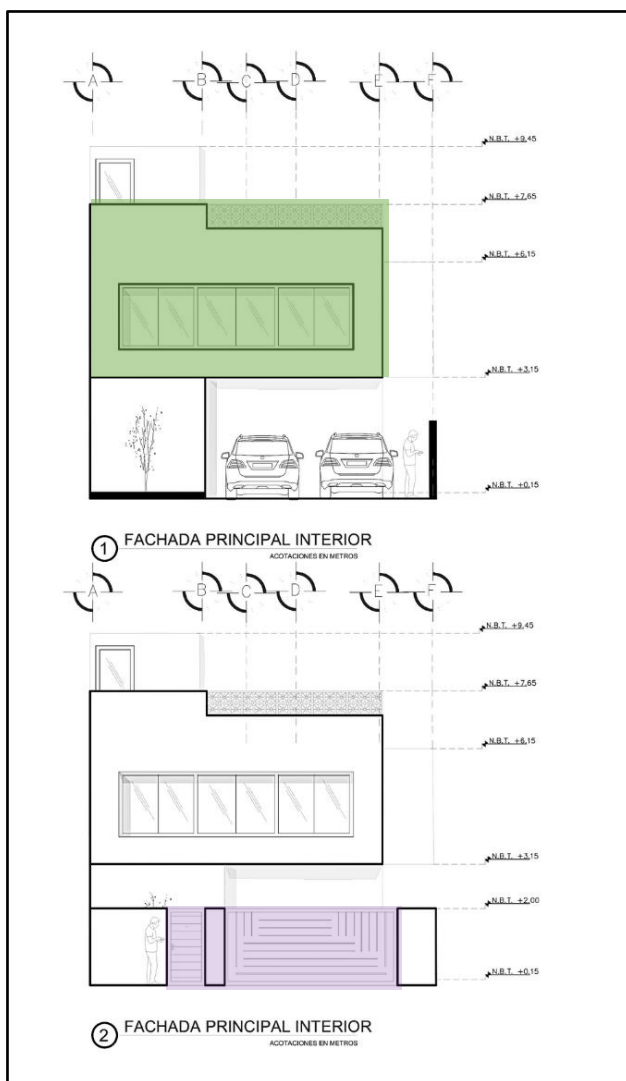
Plano arquitectónico Fachada Principal primera propuesta. Elaboración propia. (YPHC 2025)
